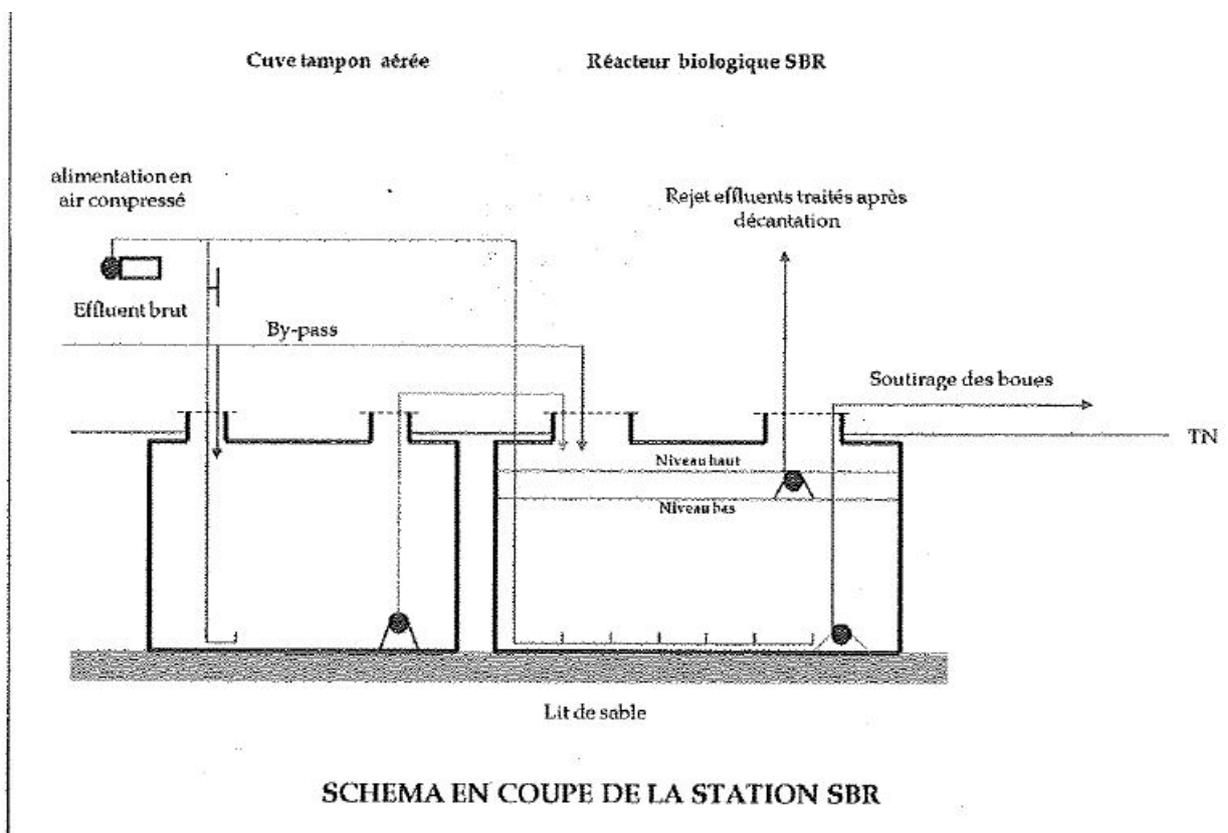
Schéma en coupe d'une station SBR (CDA 63)
